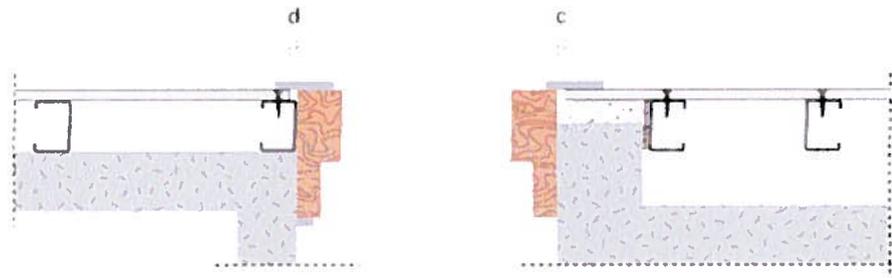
Aplicação de elementos construtivos que definem as aberturas.
